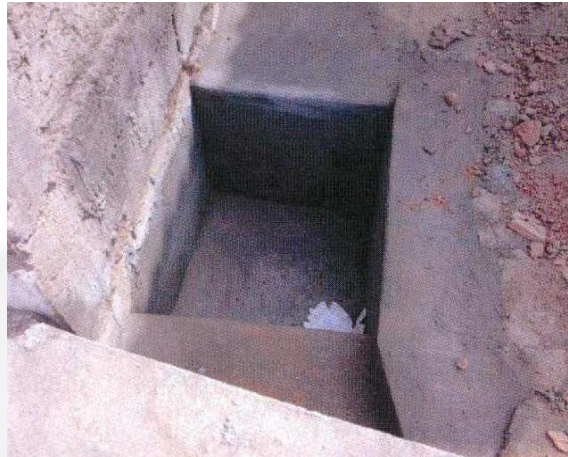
Canaletas de drenagem pluvial. Foto 12: Caixa de sedimentação (drenagem pluvial).
